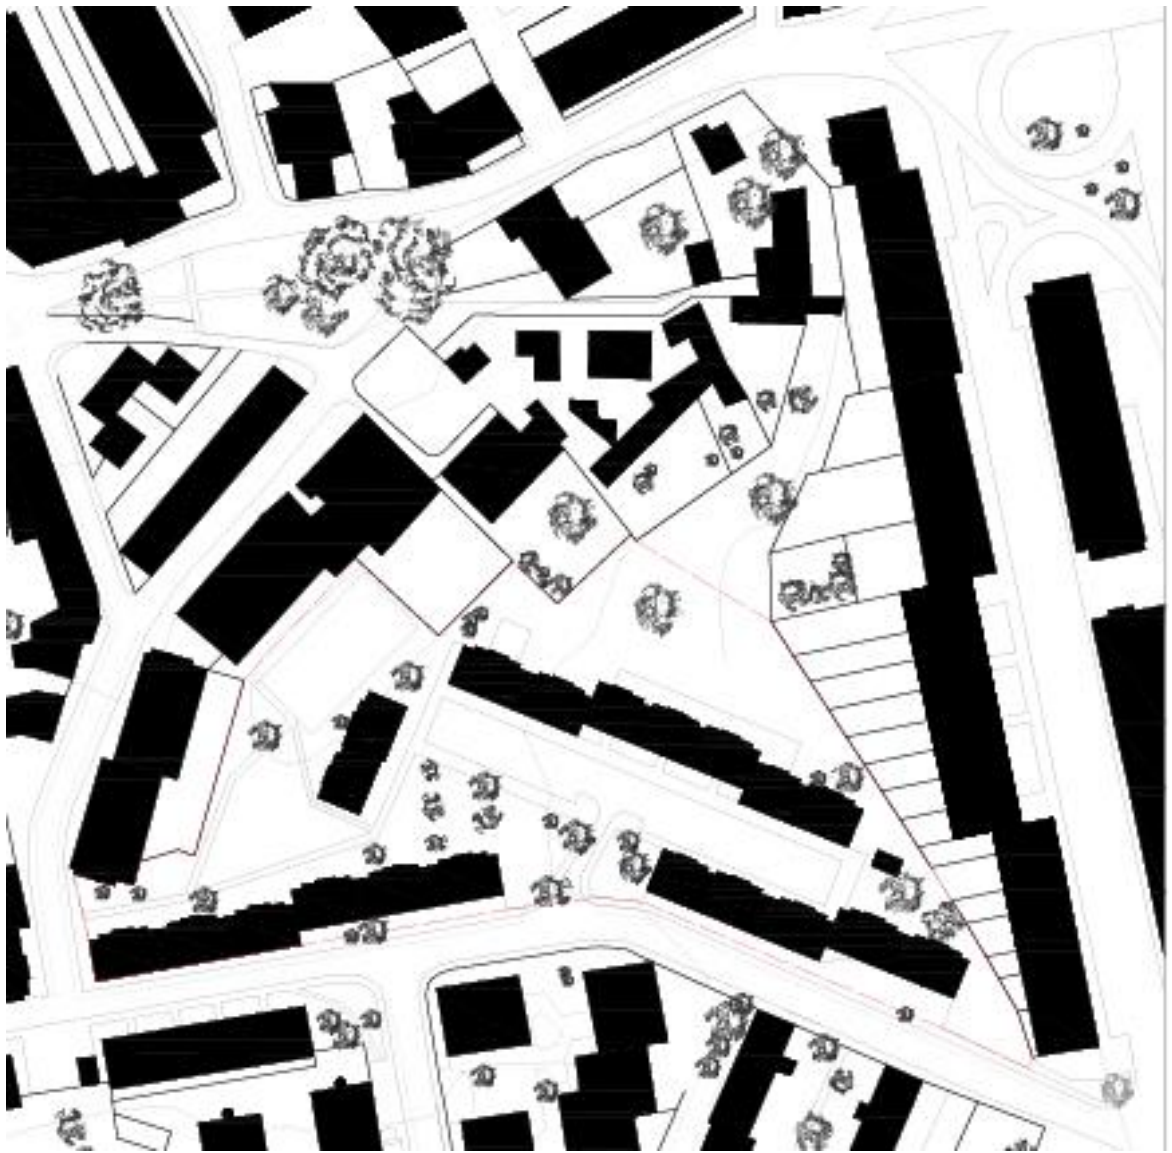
Planta do Bairro Social de Santa Tecla e envolvente
